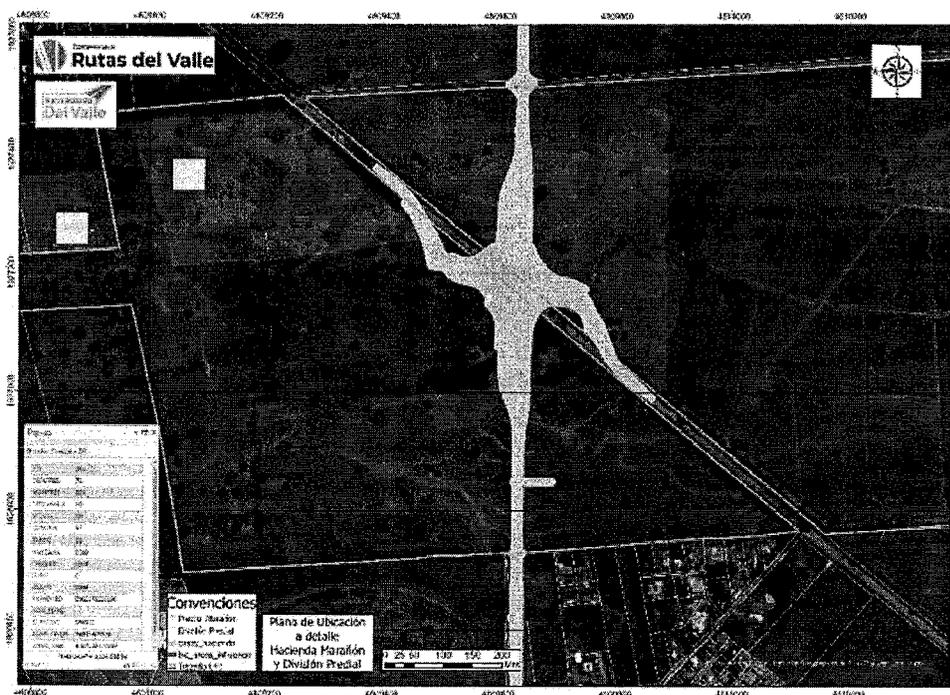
Detalle del área del predio Hacienda El Marañón en la zona de intervención del proyecto
